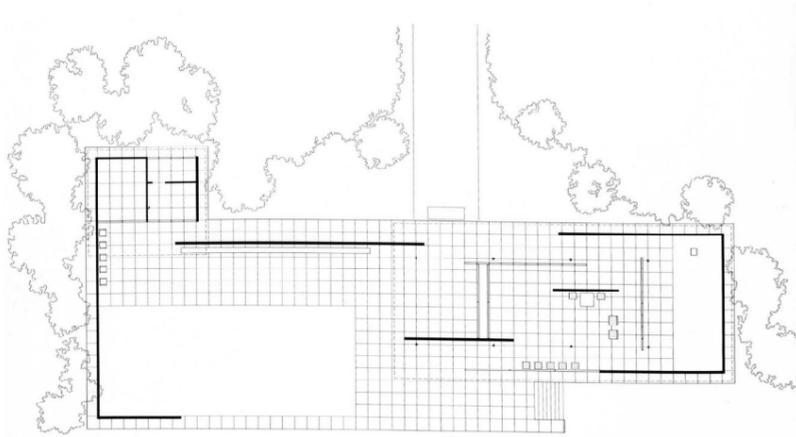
Grundriss: Der deutsche Pavillon, Mies van der Rohe, 1929
